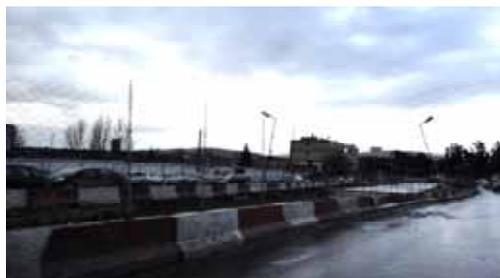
état actuel de l'espace au cours des travaux sur la RN5
